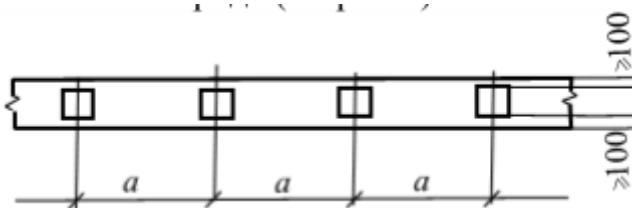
Схема расположения свай в рядовом фундаменте
